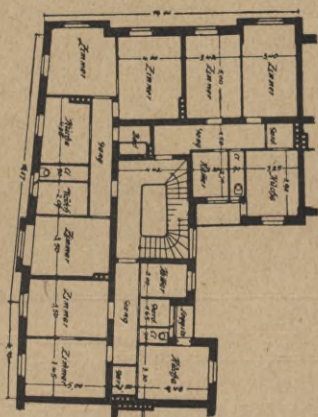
Häusergruppe Ecke Landhaus- und Talstraße, Stuttgart.
